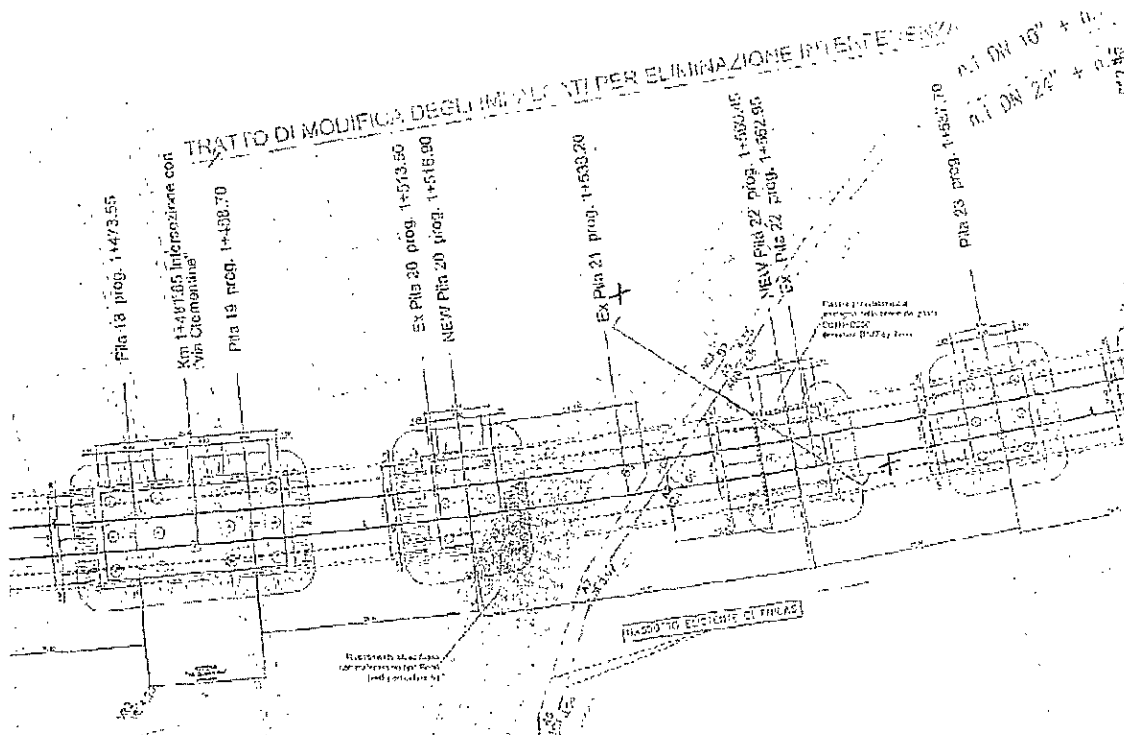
Stralcio planimetrico fondazione e sezioni soluzione proposta in variante (ingrandimento)
